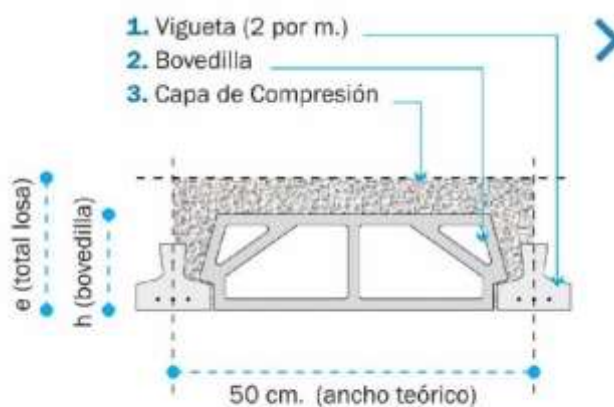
Ejemplo de elevación de la planta. (Tensolite, 2020)
